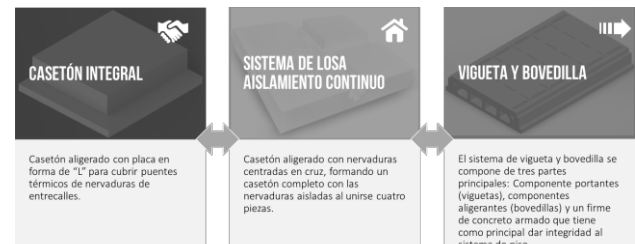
Tipos de sistemas constructivos para losas utilizadas en la Zona Norte de México.
